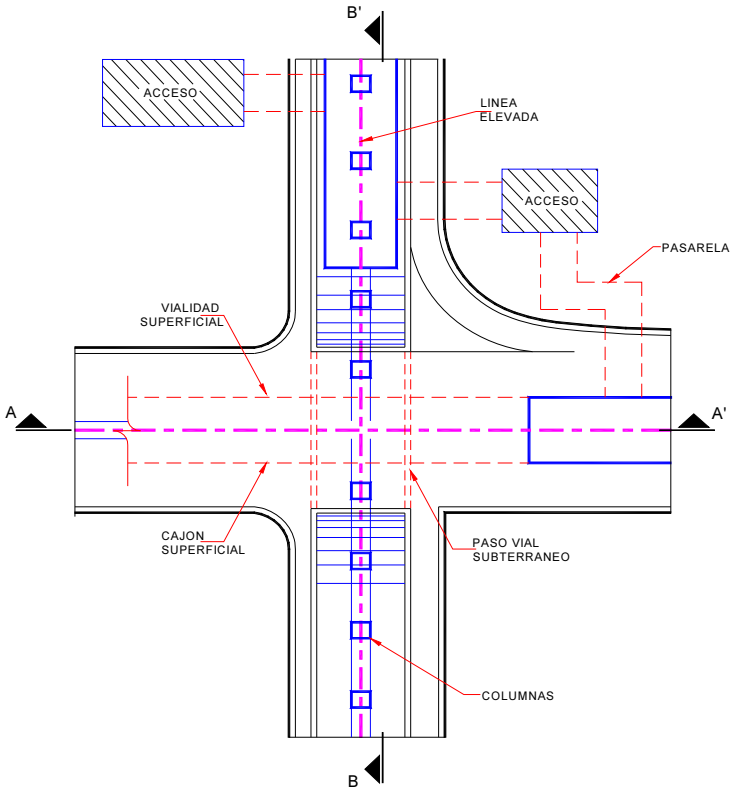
Planta del cruce de las avenidas donde se alojarán dos líneas de metro.
